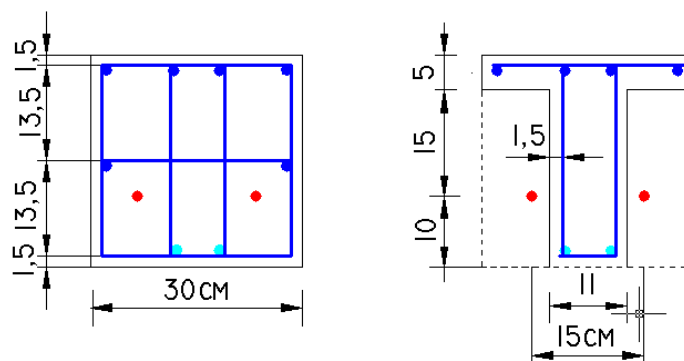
Cortes AA' e BB' das seções da viga.
